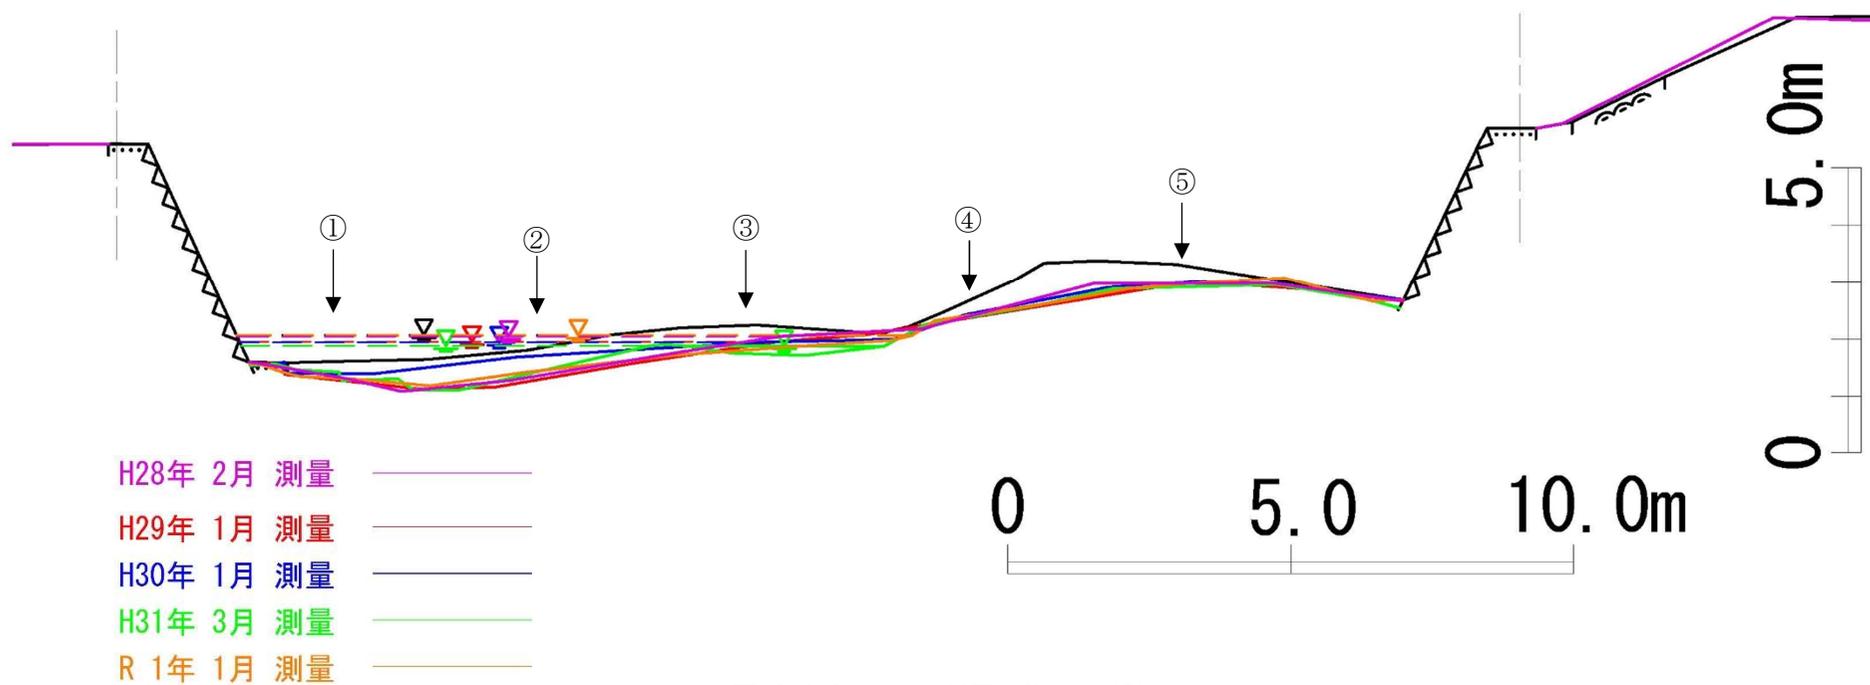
(1) 横断面図 (No. 1L, 1R)
